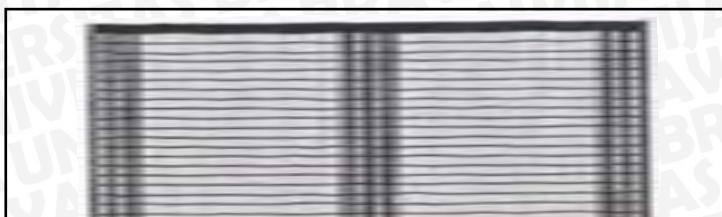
Kepala Kolom pada Ruang Kerja
